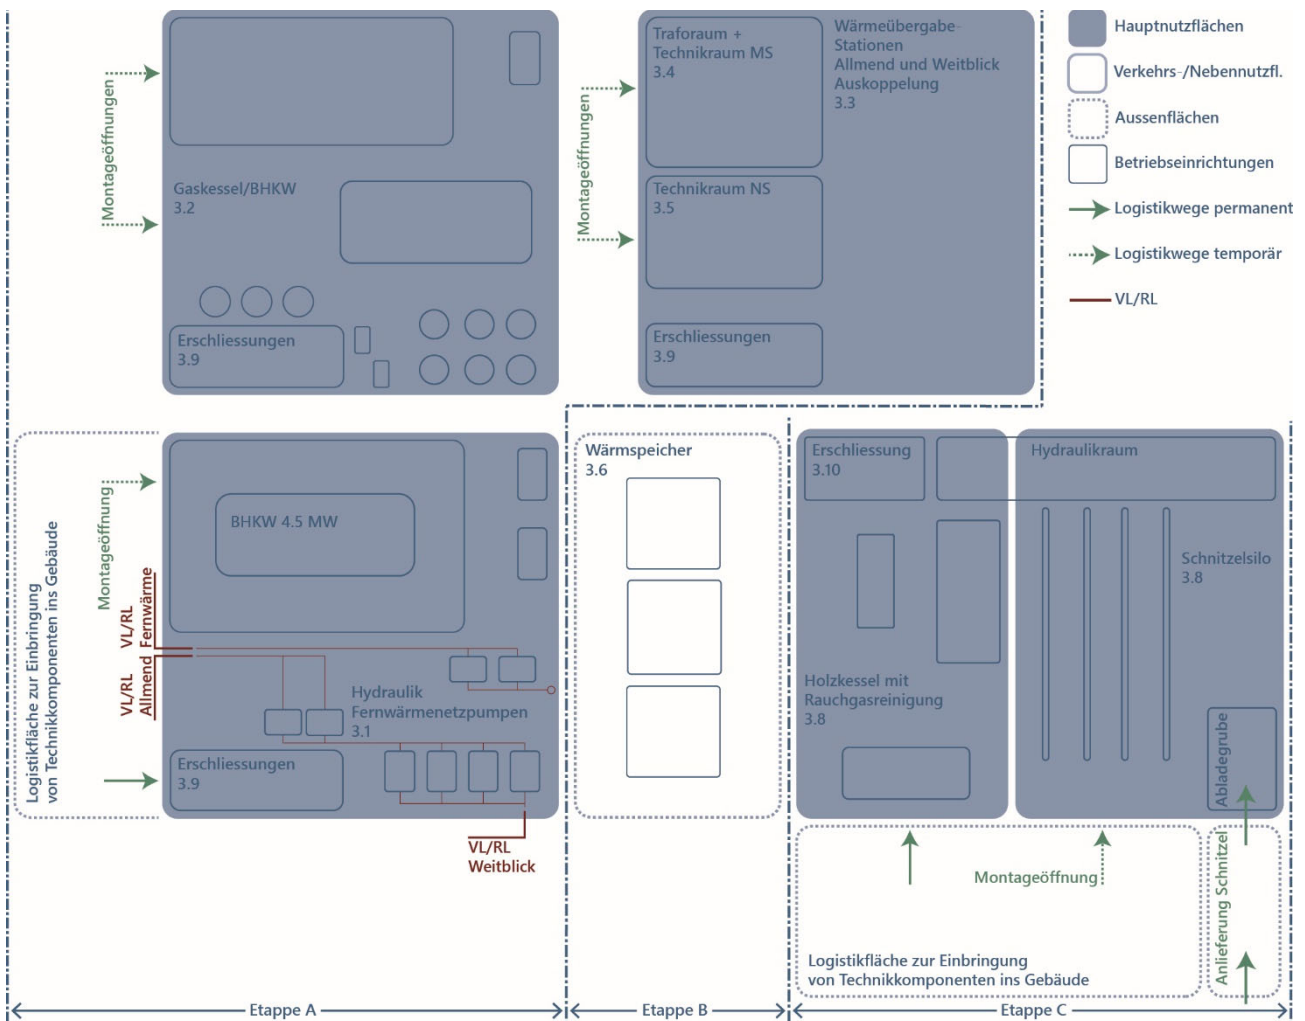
Organisationsschema Energiehub (detaillierte Angaben zu den Betriebseinrichtungen siehe Grundlage [C2])
